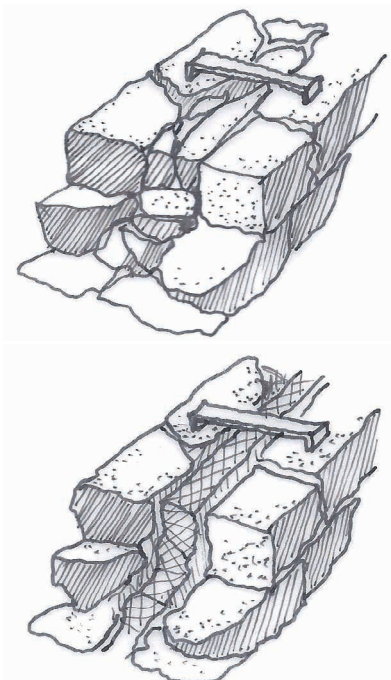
Propuesta reinterpretando la solución tradicional con aislamiento intermedio, muros de carga interior y anclaje de las hojas con grapas de acero galvanizado, conformado un muro capuchino de mampostería. Dibujo de la autora
